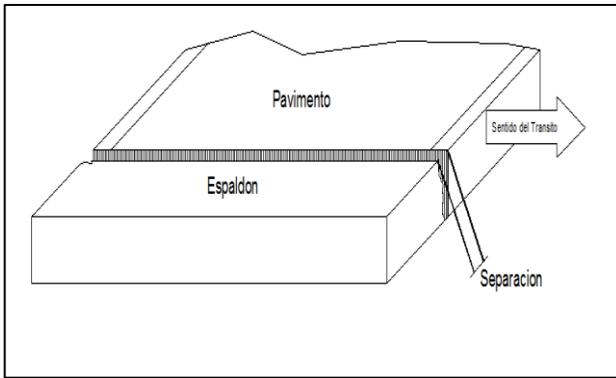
Esquema de separación entre la berma y el pavimento (Autor, 2013).
